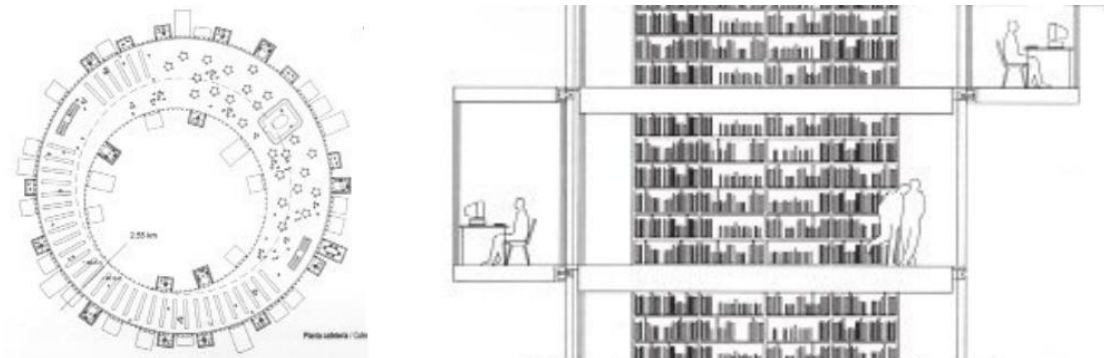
Planta da Biblioteca Central de Brabantt
